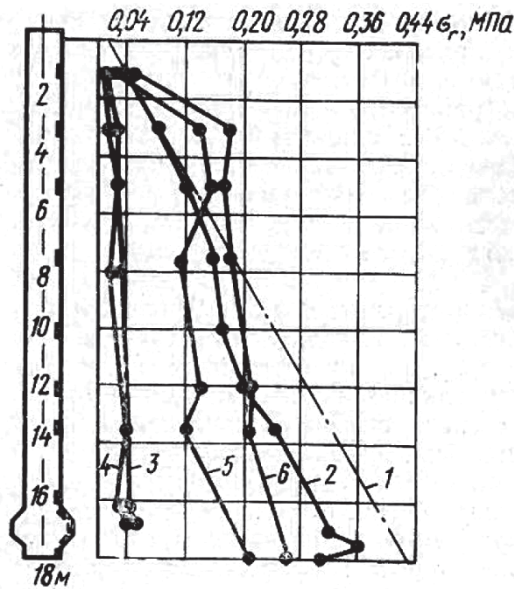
Эпюры радиальных давлений σ_r по длине сваи № 7 после бетонирования и при нагружении сваи: 1 – гидростатическое давление бетона; 2 – после заполнения скважины бетоном; 3 – через 7 суток; 4 – через 28 суток; 5 – при нагрузке 6500 кН; 6 – при нагрузке 7500 кН
